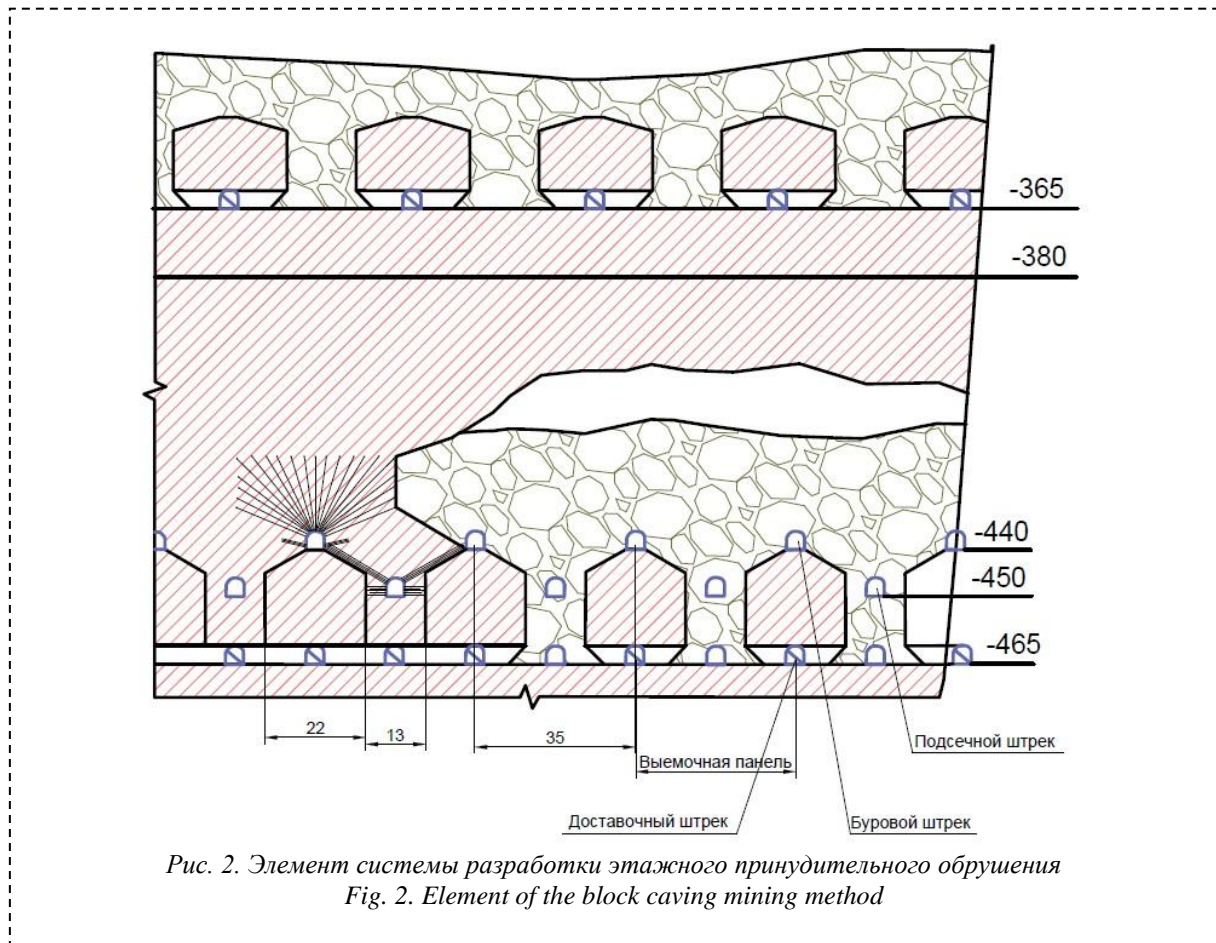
Элемент системы разработки этажного принудительного обрушения
